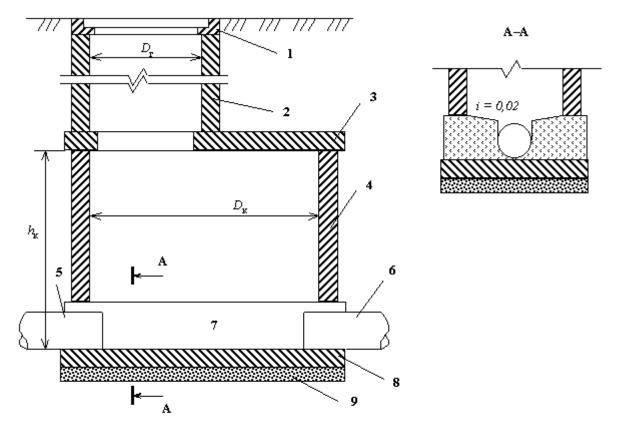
Основные конструктивные элементы смотрового колодца 1 – люк с крышкой; 2 – горловина колодца; 3 – плита перекрытия; 4 – рабочая камера; 5 – подводящая труба; 6 – отводящая труба; 7 – открытый лоток; 8 – плита основания; 9 – песчаная подготовка
